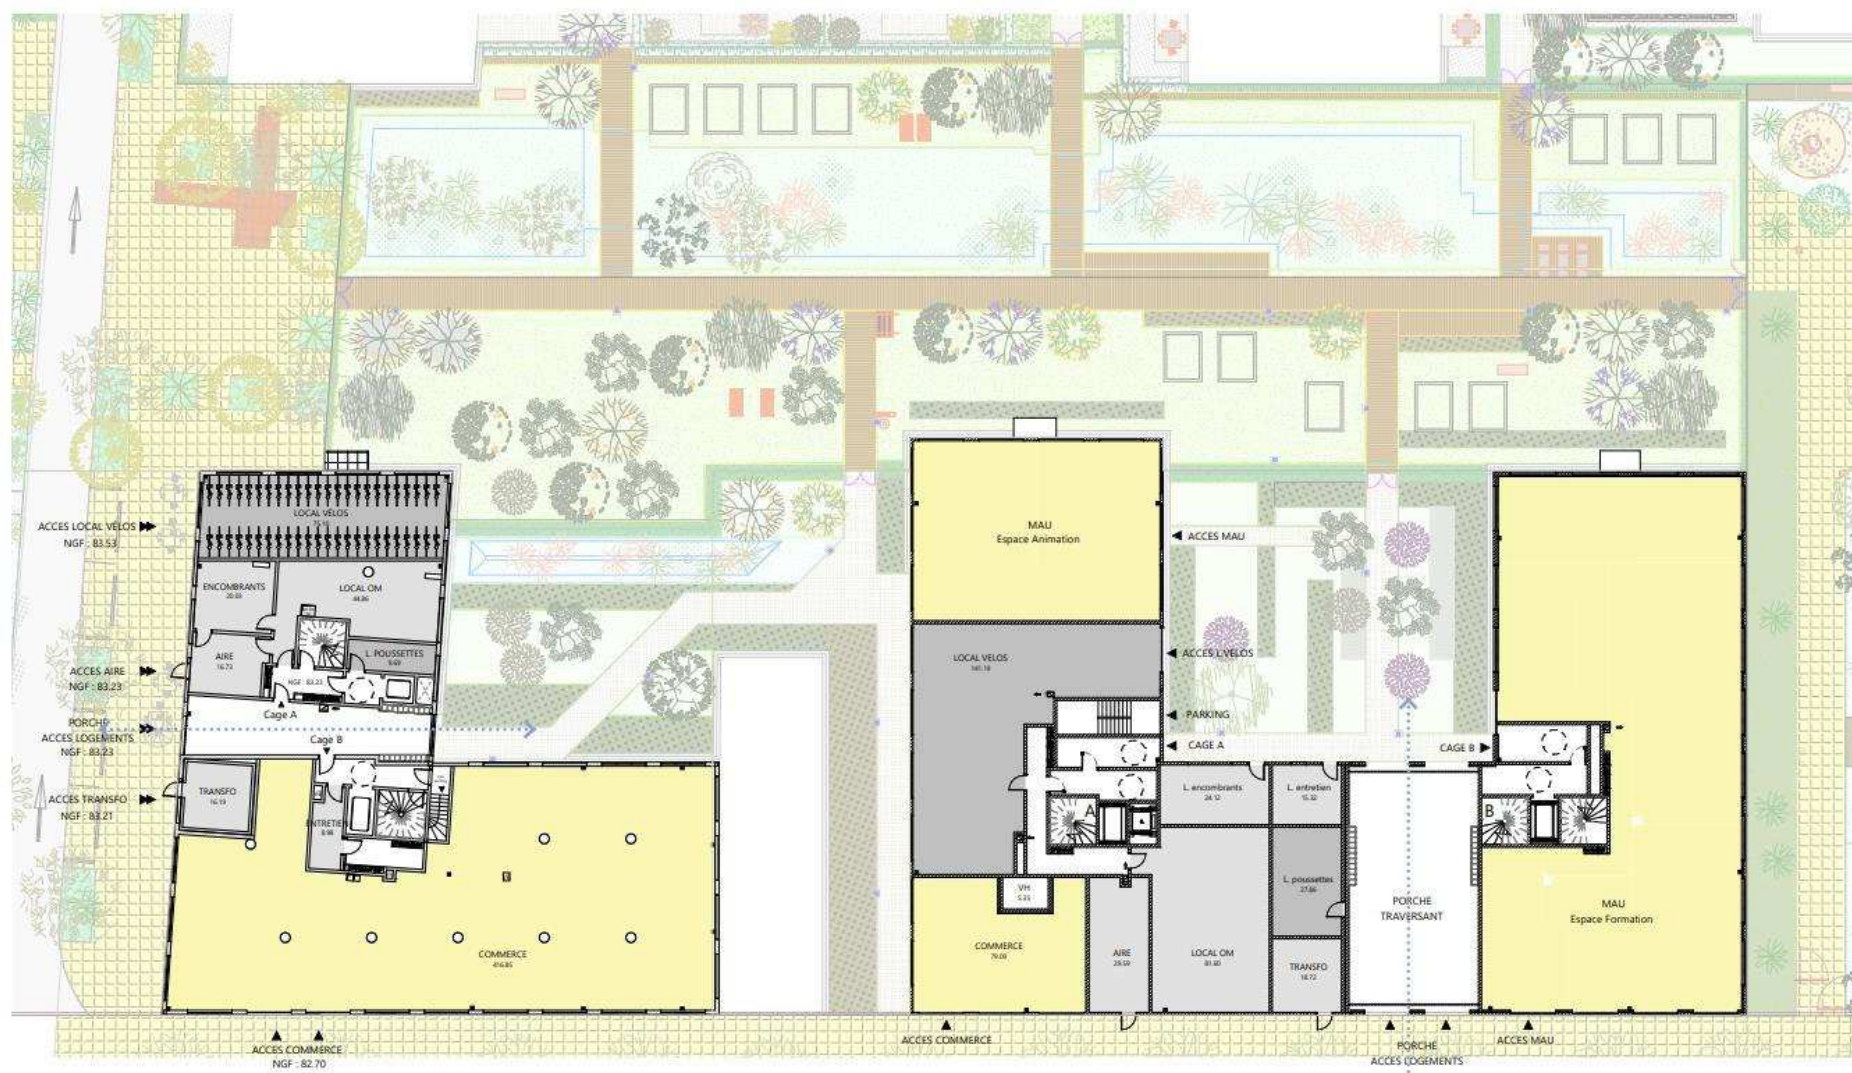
Plan masse du RDC des bâtiments du lot 3.2
